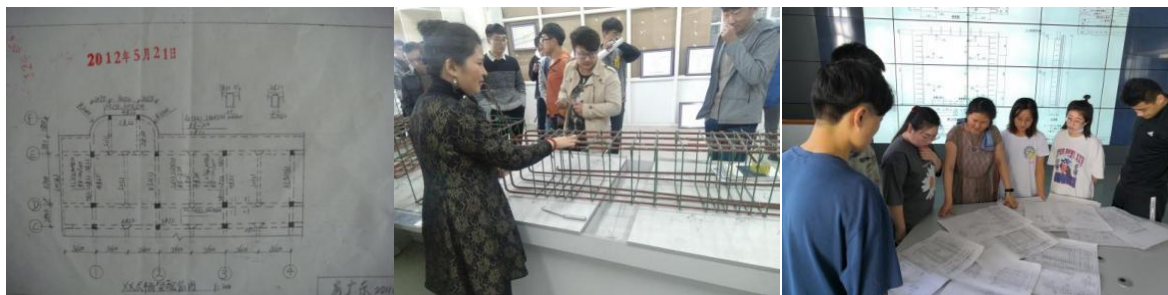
钢筋混凝土框架梁平法图—模型—深化设计—钢筋翻样验证
